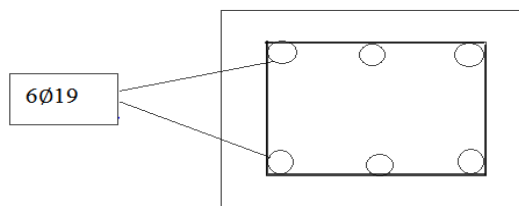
Ferrailage du poteau en traction selon le code ACI
